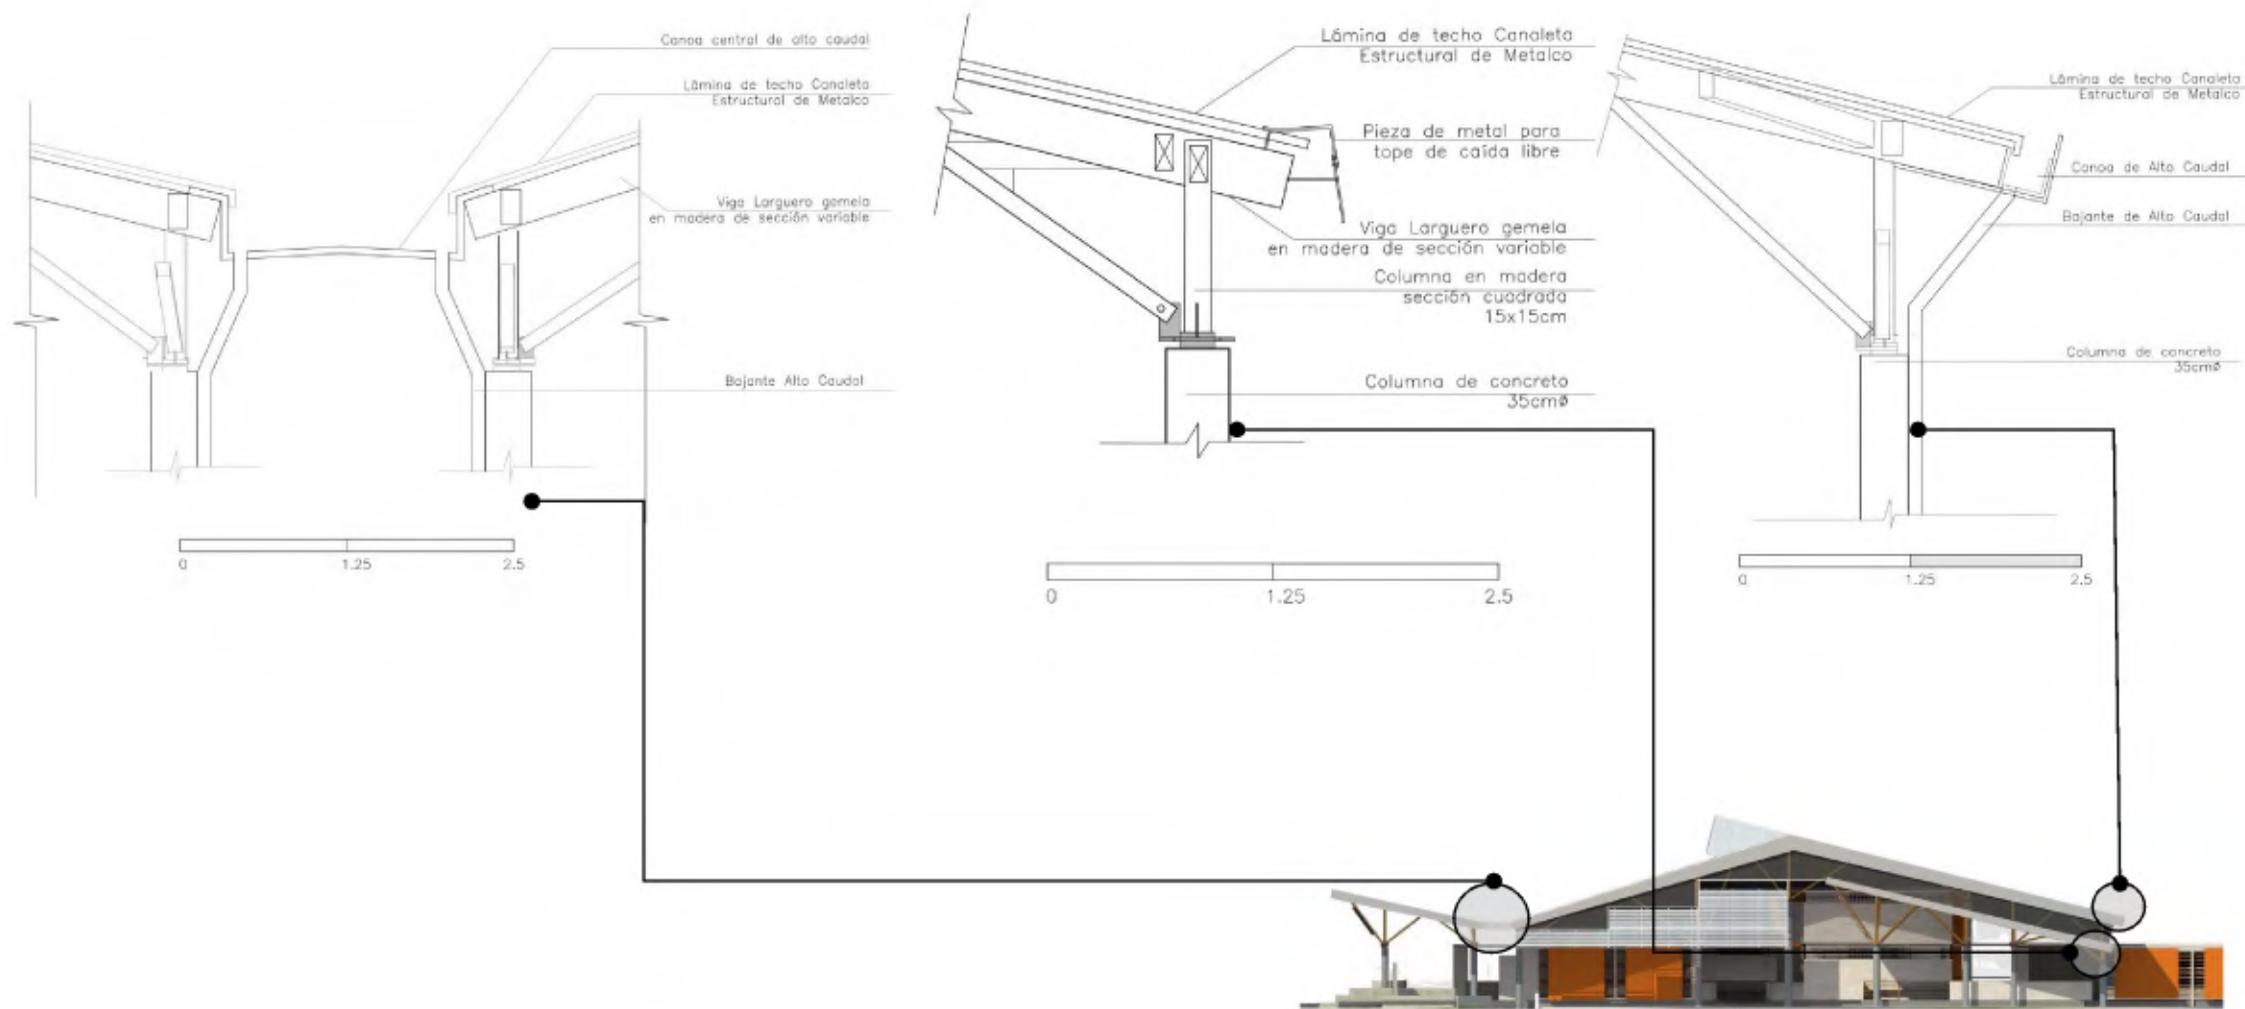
izq. DETALLE CANOA CENTRAL. Imagen 96.2 centro. DETALLE CAÍDA LIBRE. Imagen 96.3 der. DETALLE CAIDA LIBRE. TERMINAL DE CRUCEROS. (Fuente: Elaboración Propia)
